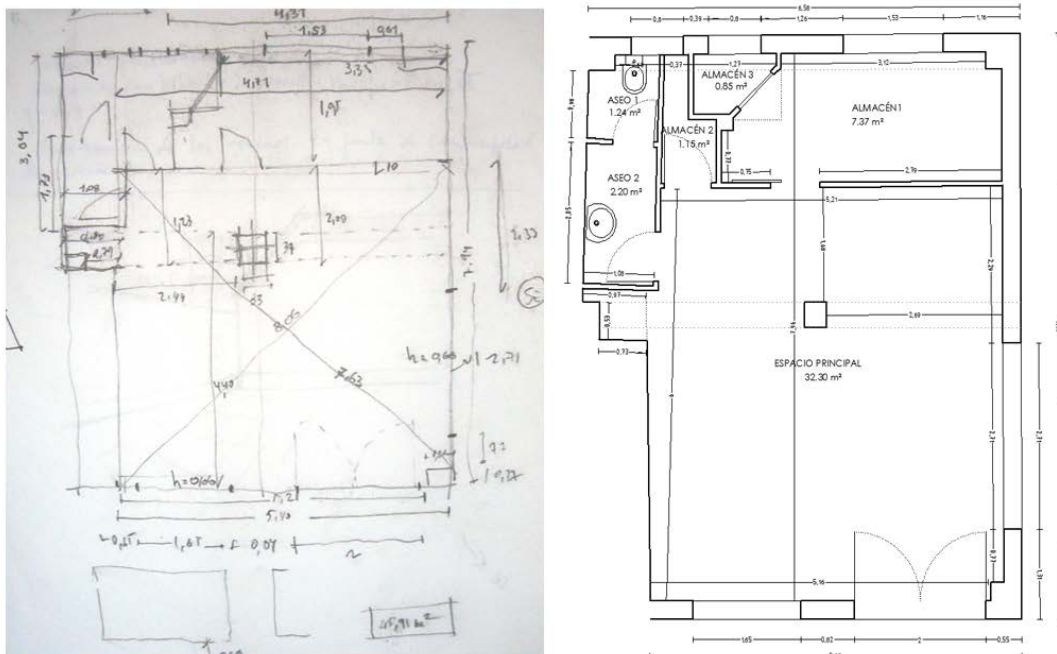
Croquis acotado y plano a escala. Fuente: <https://acortar.link/qlxy9>
